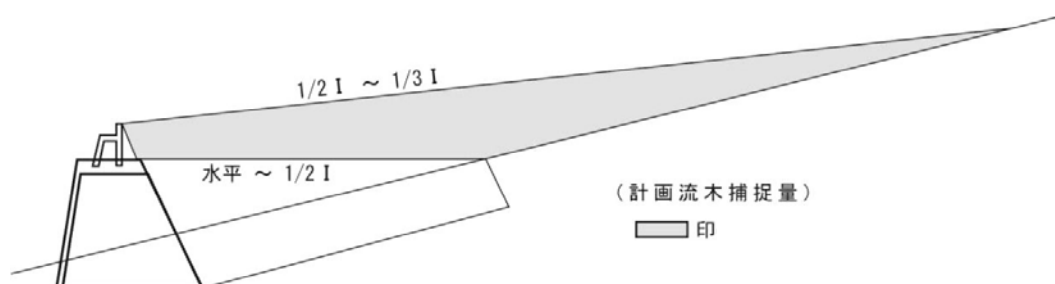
標準的な設置方法の場合の鋼製流木捕捉工による計画流木捕捉量の考え方
